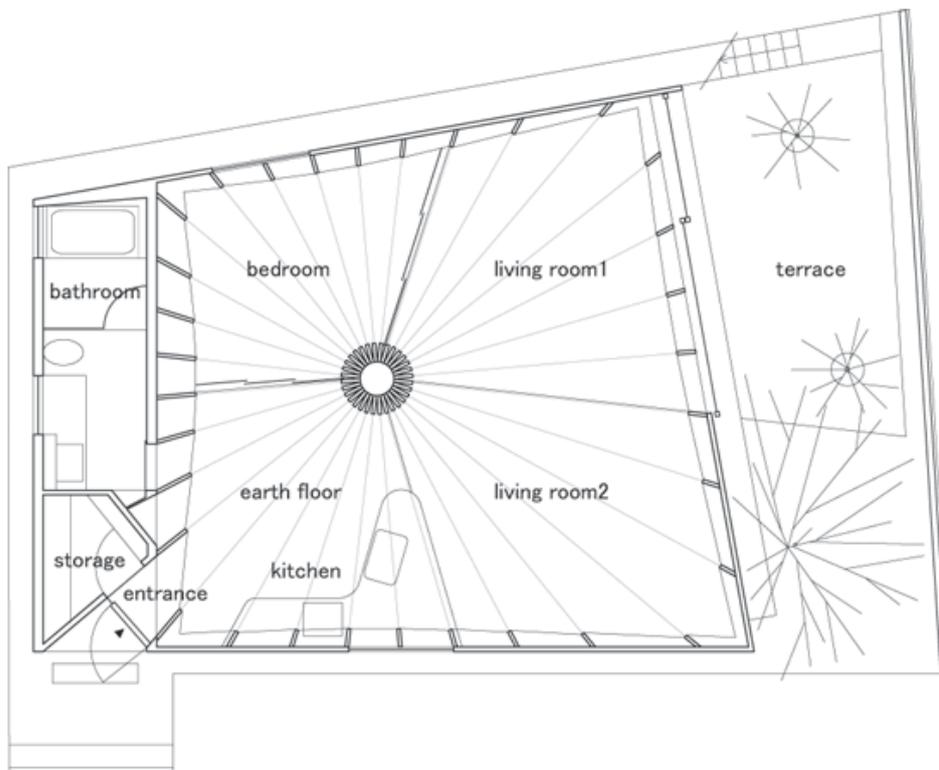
Tree House, Grundriss, Quelle: [www.designboom.com](http://www.designboom.com)
